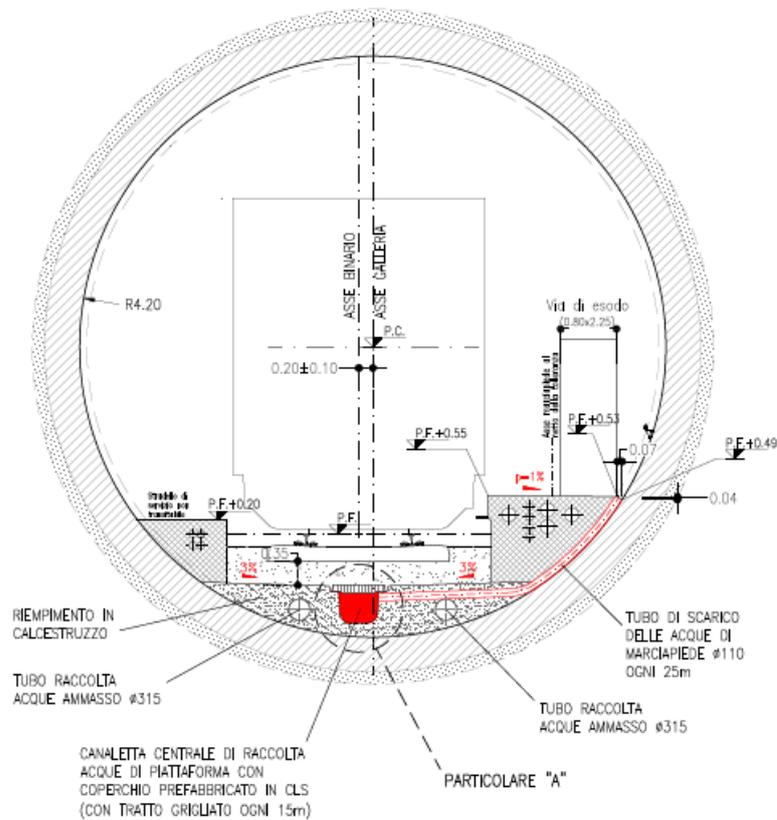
Sezione trasversale tratta in meccanizzato – Collettamento acque piattaforma – Sezione corrente
